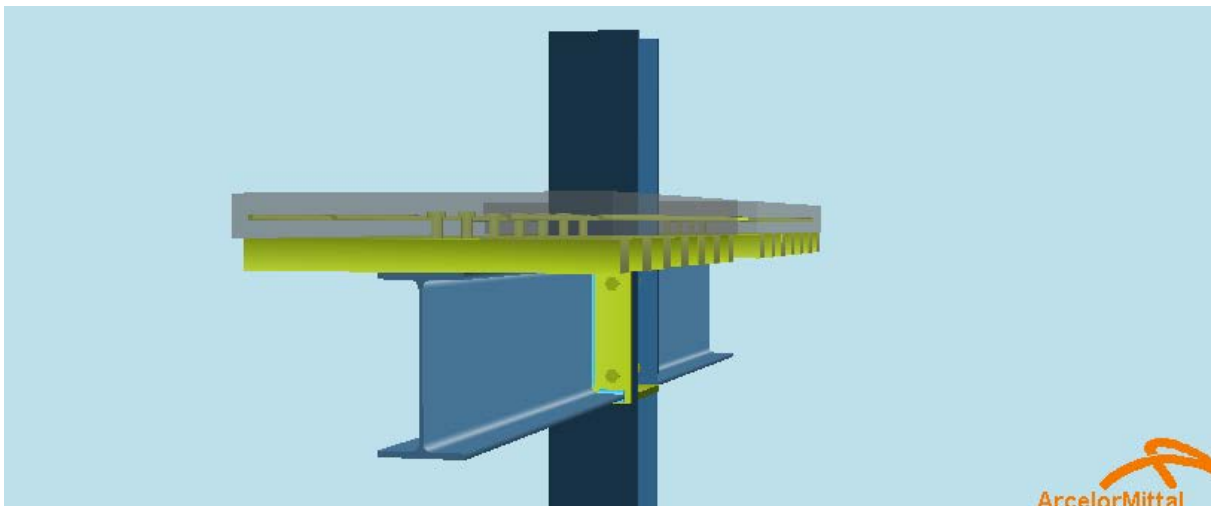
Vue en 3D de l'assemblage (Exemple2)
